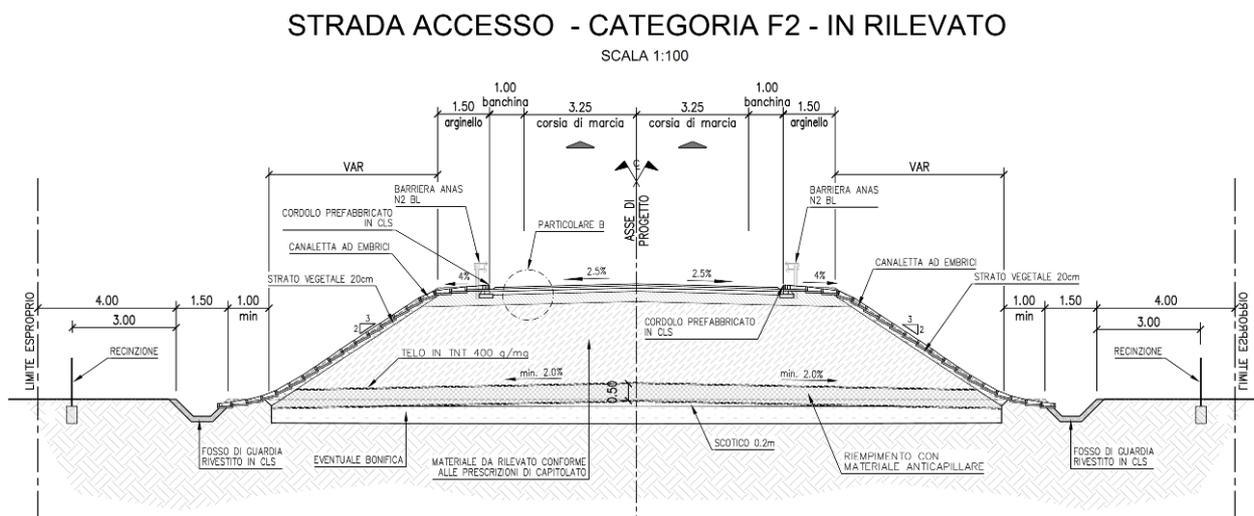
Sezione tipo in rilevato dell'asse secondario – Strada di Accesso alla Dorsale Consortile CASIC
